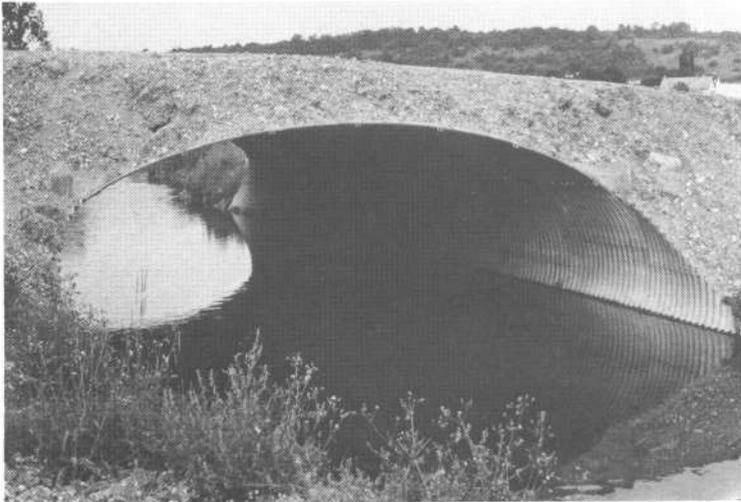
Buse elliptique à grand axe horizontal avec poutre de poussée en béton armé
